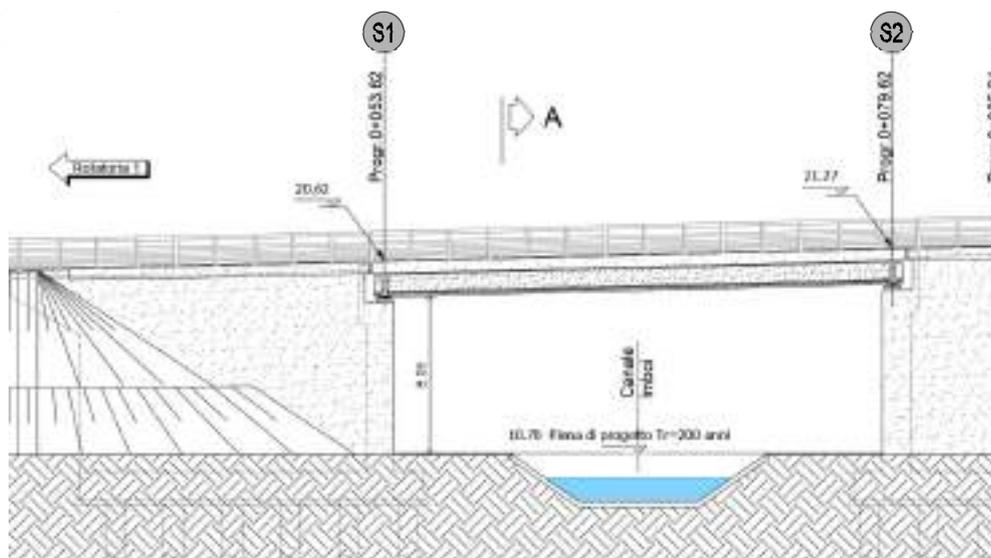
Prospetto del ponte su canale Imboi svincolo Capoterra – Casci.
